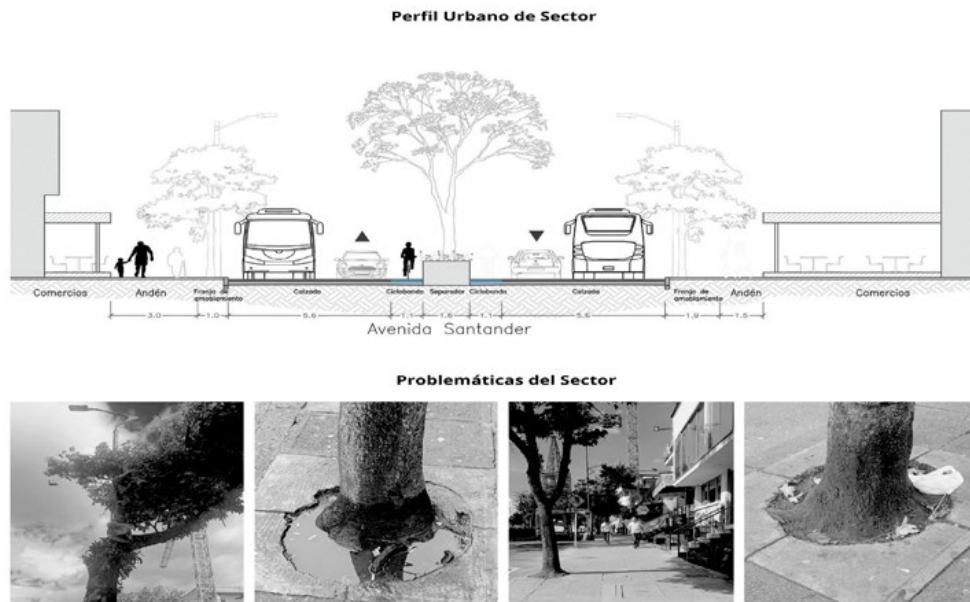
Perfil Urbano y Problemáticas de Sector El Cable. Fuente: elaboración propia (2025).
